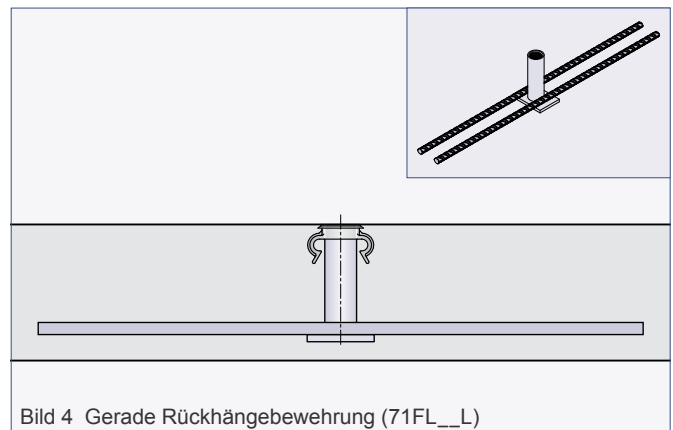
Gerade Rückhängebewehrung (71FL__L)
